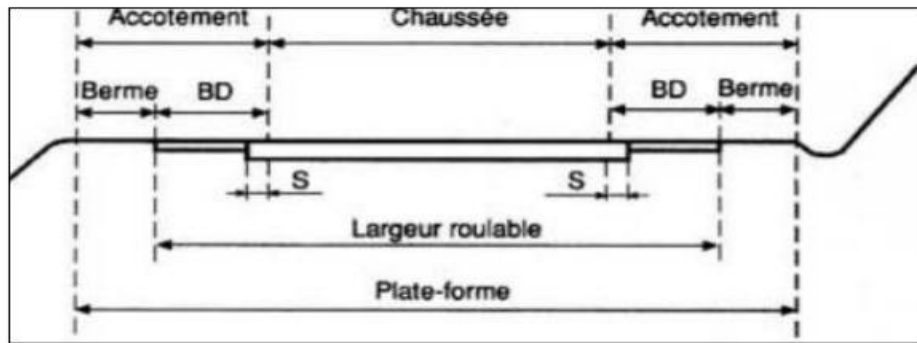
Profil en travers d'une route à 2 ou 3 voies.
